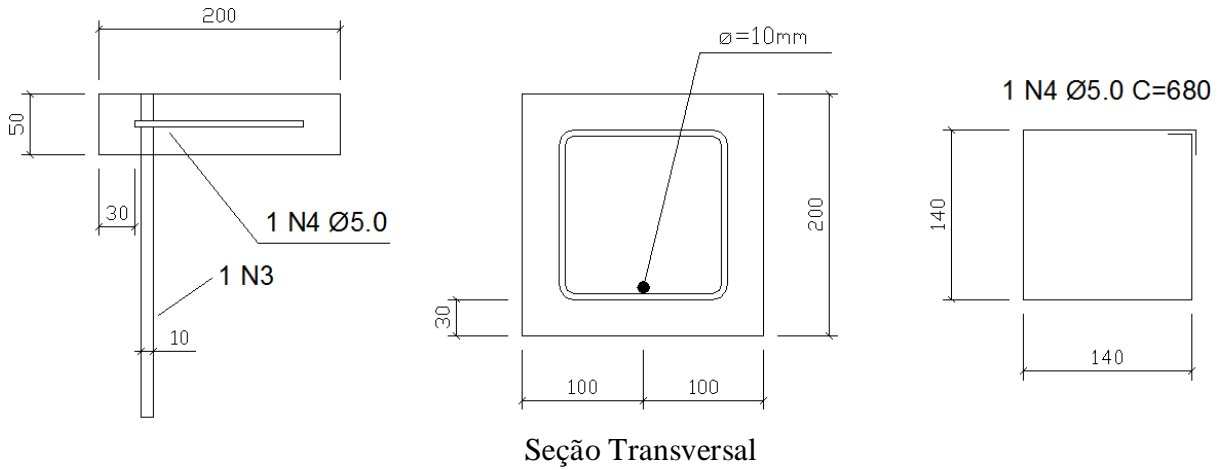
Detalhe do modelo de arrancamento com barras retas de 10 mm com estribos (dimensões em mm)
